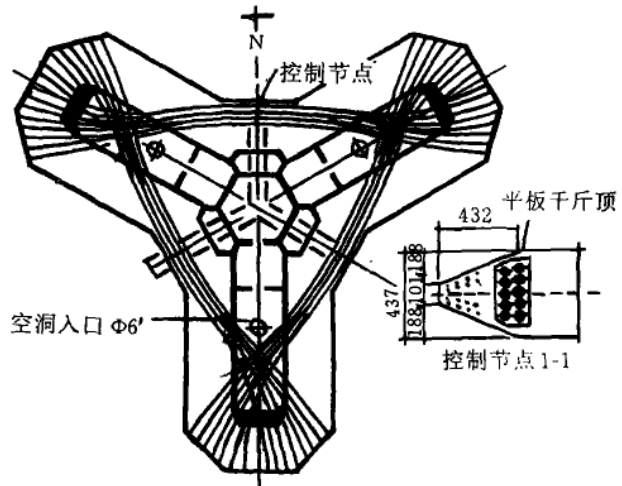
基础预应力筋平面布置和安放平板千斤顶的控制节点断面
